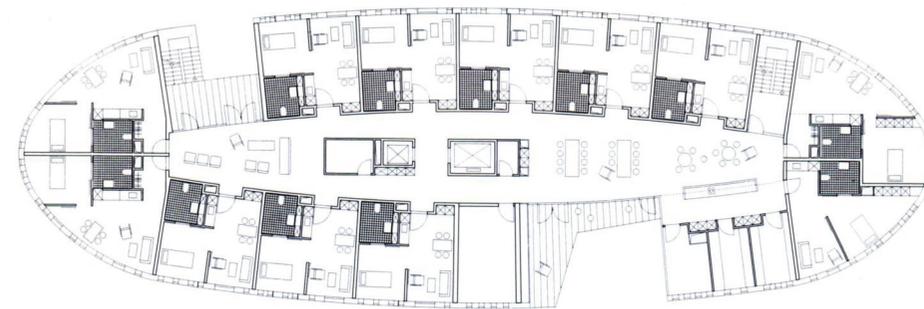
Grundriss 1. Obergeschoss M 1:500
